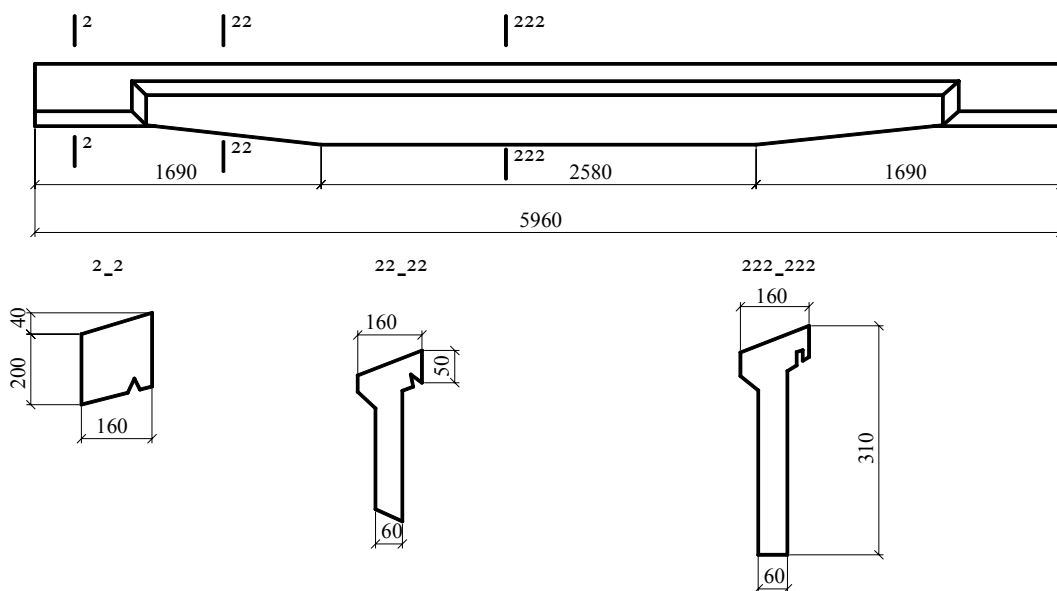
Залізобетонний прогін із скошеною балкою
